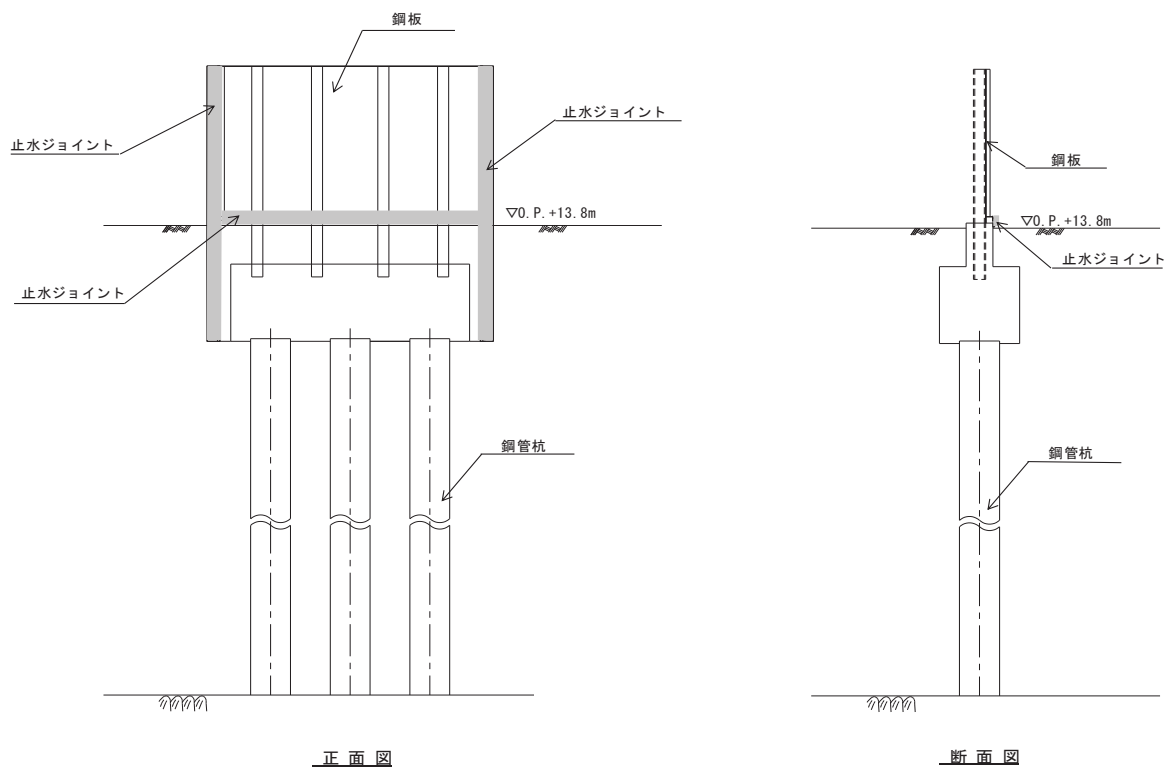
鋼製遮水壁（鋼板）の構造概要
